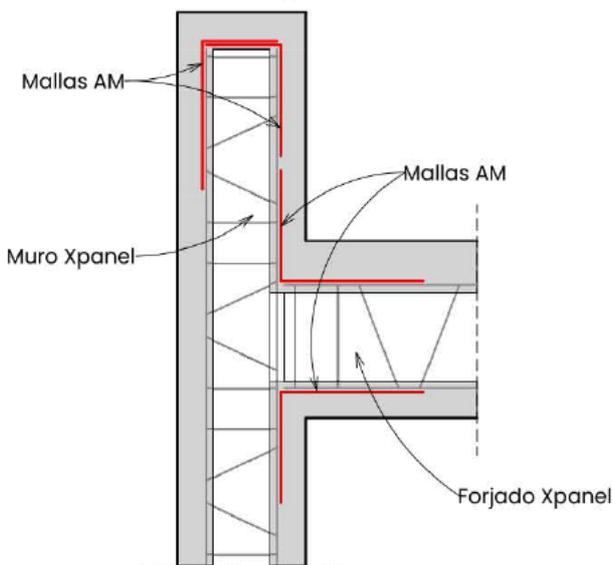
Detalle de interacción de paneles XP o XPH con elementos de hormigón armado, en caso de ser necesarios.
